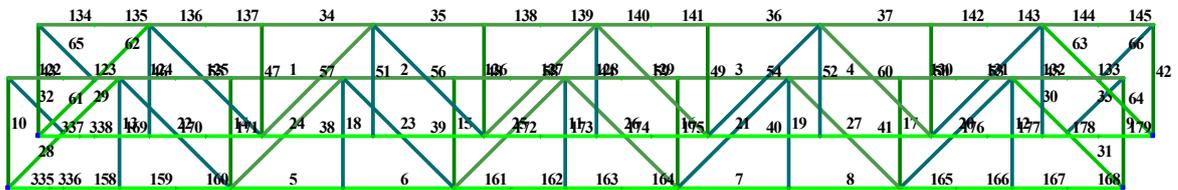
Проверка местной устойчивости элементов ферм
